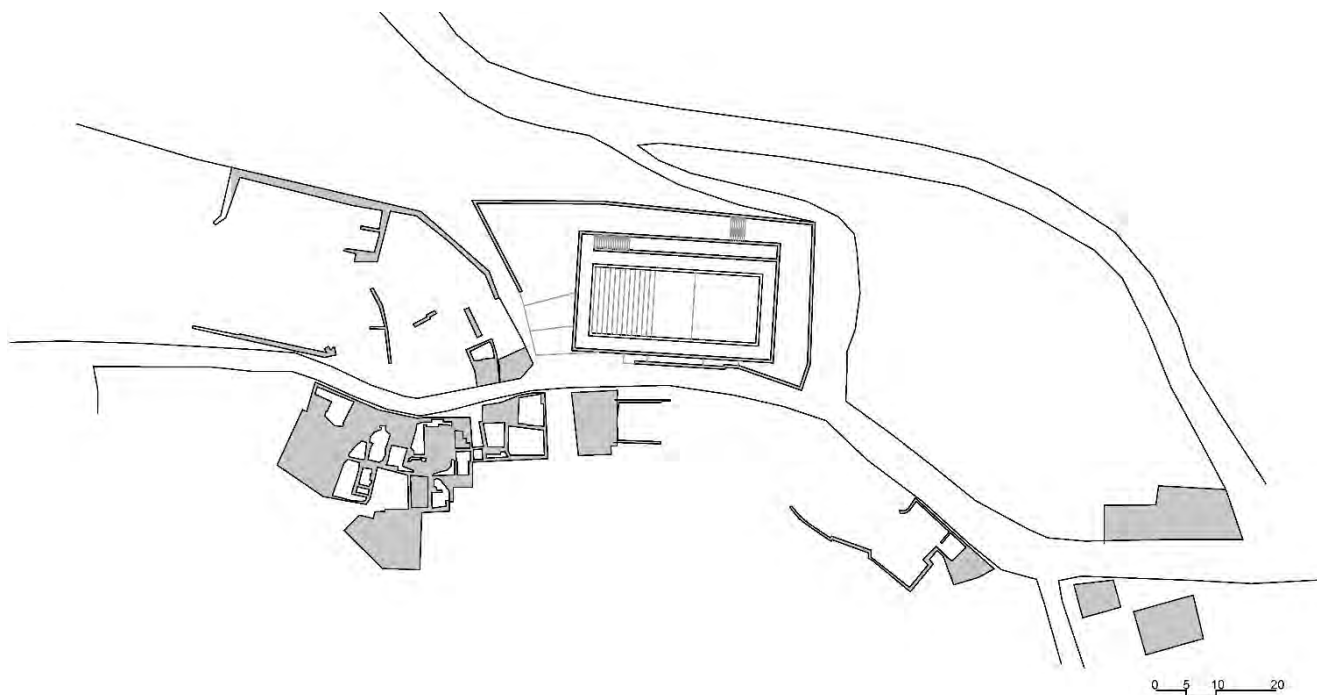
Planimetria del progetto del Teatro del Carmine di Francesco Venezia – Fonte: ri-elaborazione dell'autore
